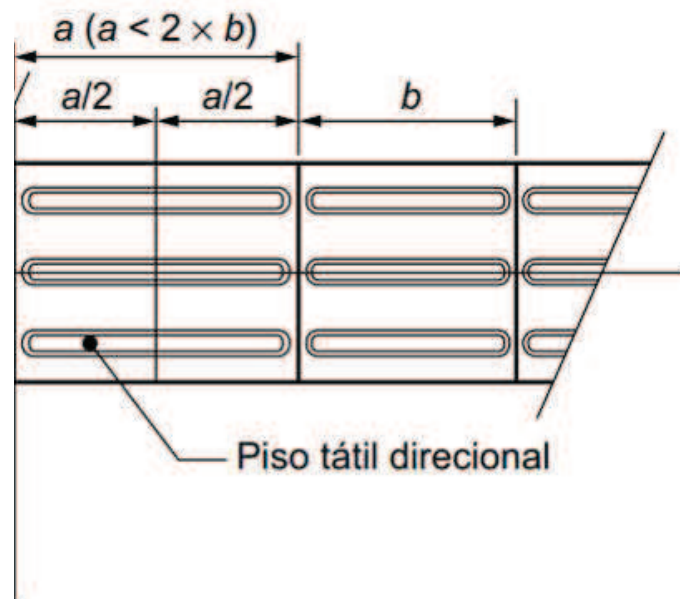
Piso tátil a ser instalado no interior da edificação.
